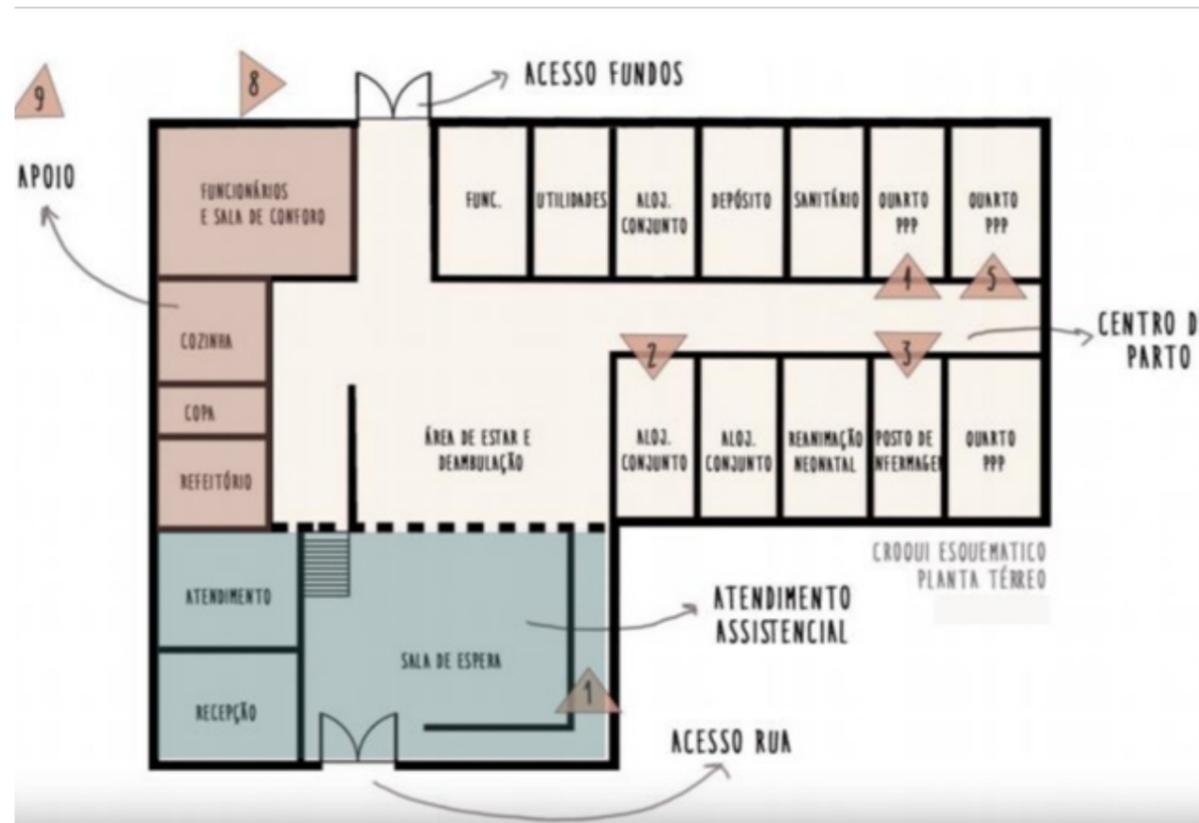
Croqui esquemático do pavimento térreo da Casa Ângela.
